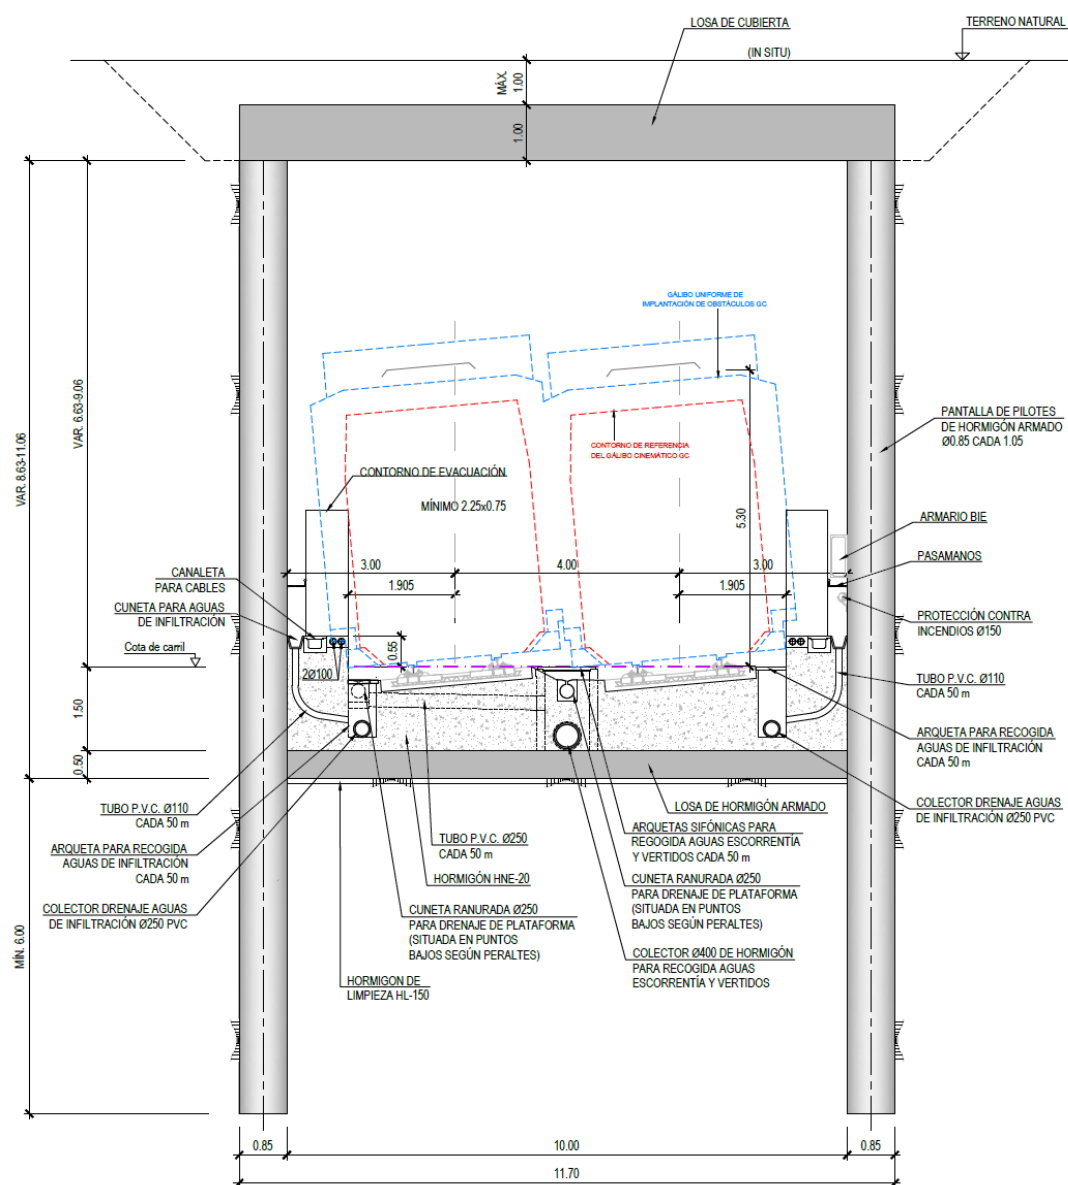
h.- Sección tipo 6 en el tramo soterrado (ST-S6).
